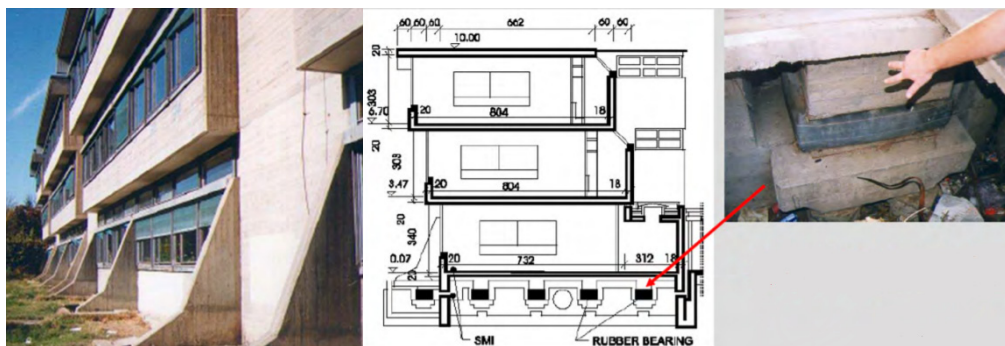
Colegio Pestalozzi, primer edificio aislado sísmicamente.
